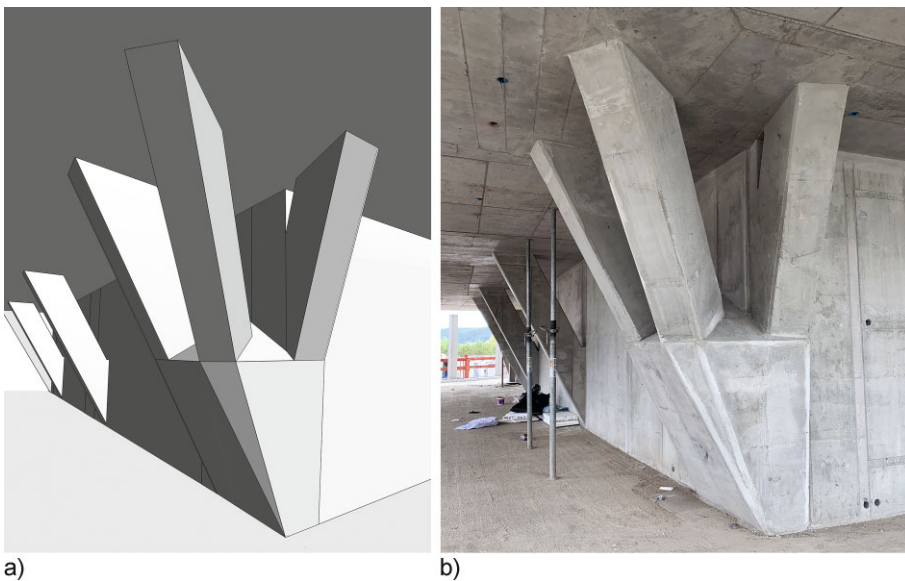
Wandartiger Träger: a) Konturmodell, b) Ausführung nach Betonage
